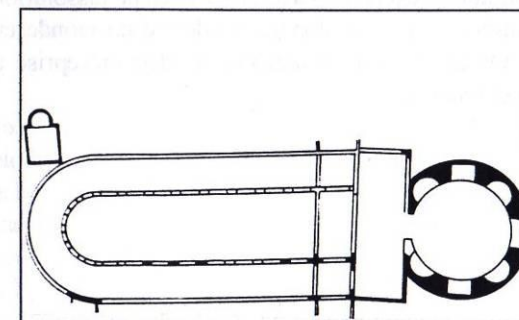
Saints Pierre et Marcellin, plan restitué de la basilique cimetiérale et de sa rotonde funéraire
